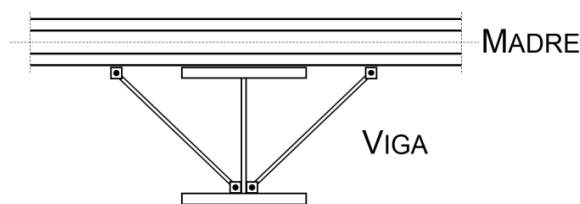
Contraventamento lateral do banzo inferior da Viga B.
